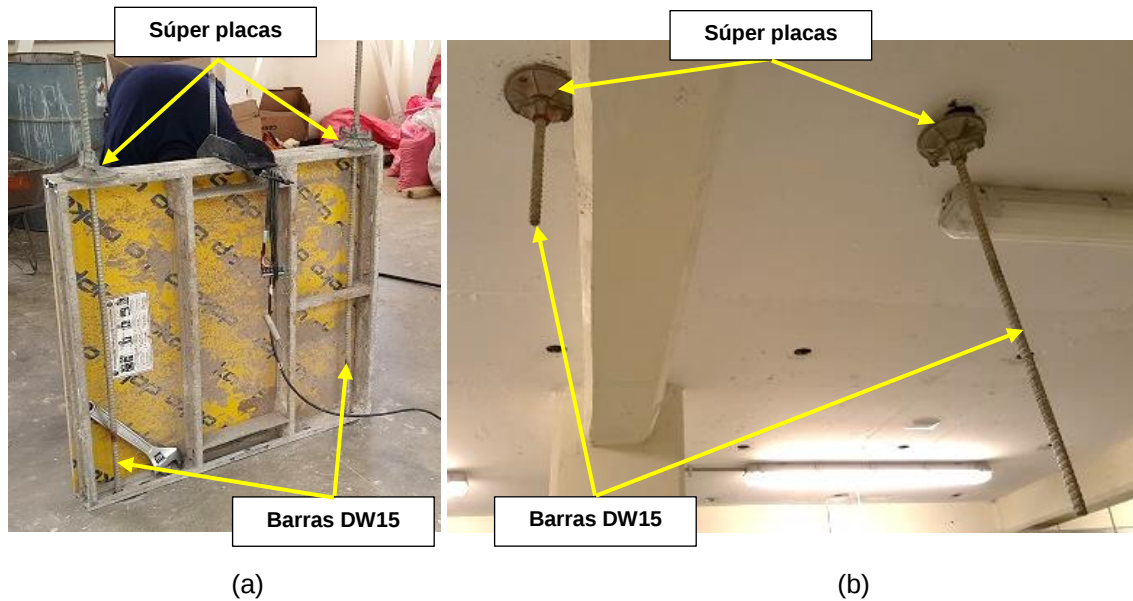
Sistema de anclaje del panel a la losa del laboratorio: (a) Por sobre la losa; (b) Por debajo de la losa
